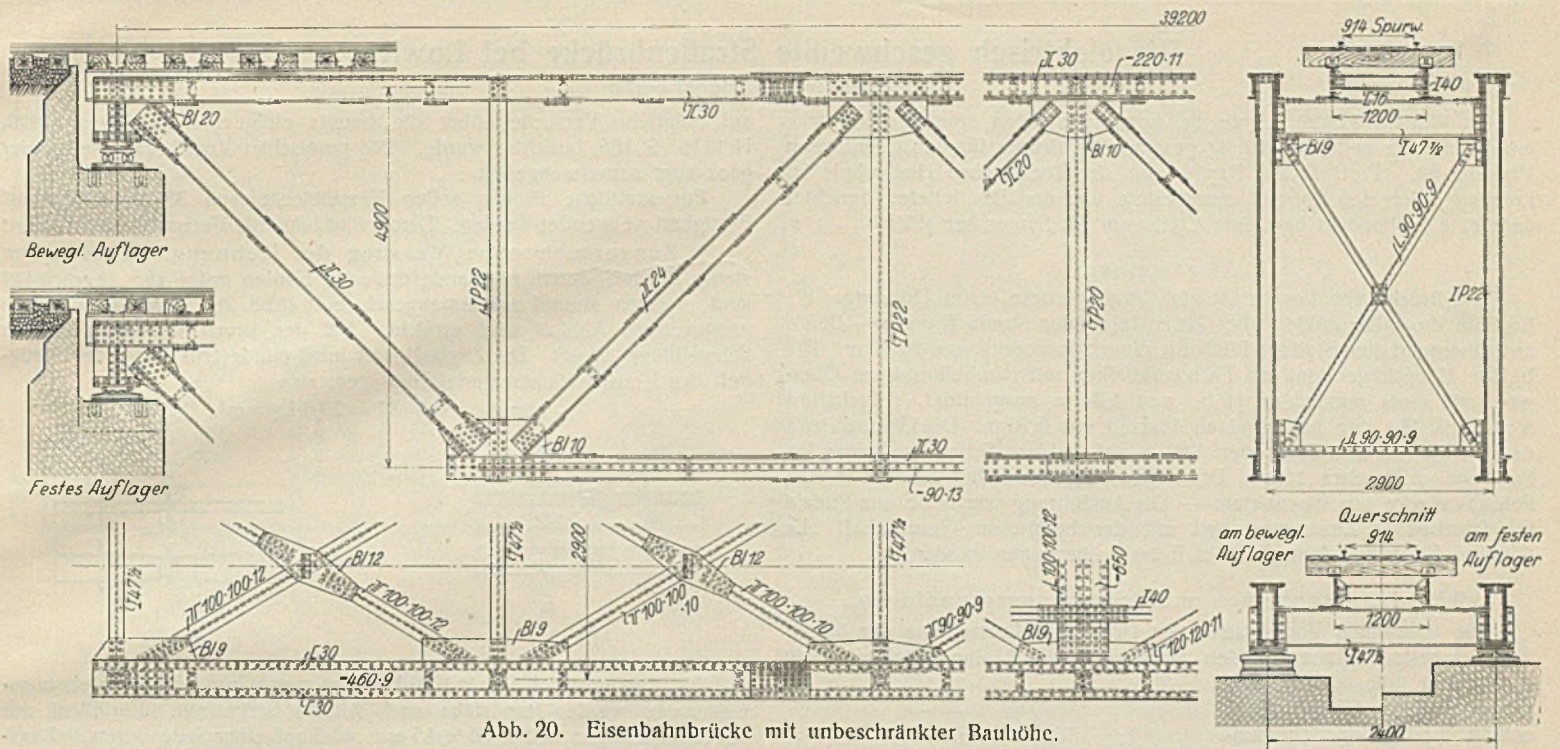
Eisenbahnbrücke mit unbeschränkter Bauhöhe.
